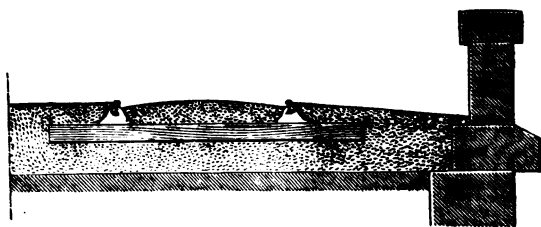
Profil de la voie sur un ouvrage d'art. $\frac{15}{1000}$.
